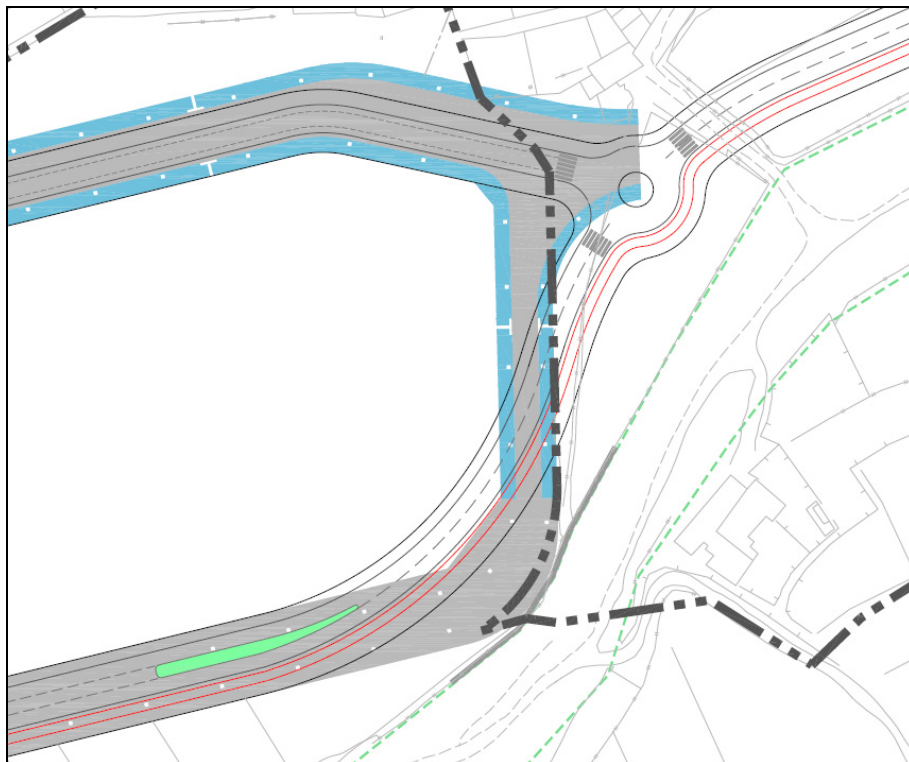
Intersección entre la vía perimetral y la vía de conexión Este. B
